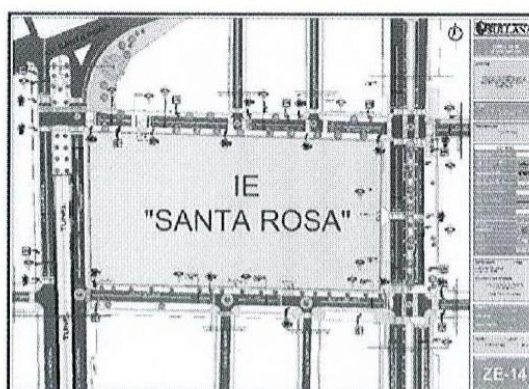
Plano General de Intersecciones de la I.E "Santa
